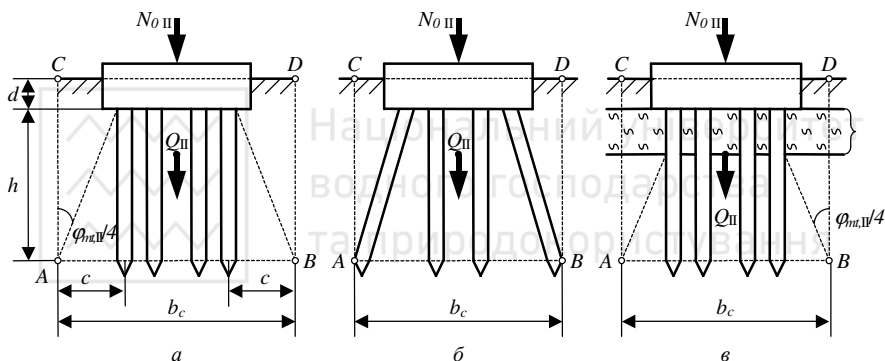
Схема до визначення меж умовного фундаменту при розрахунку осідань пальових фундаментів:
